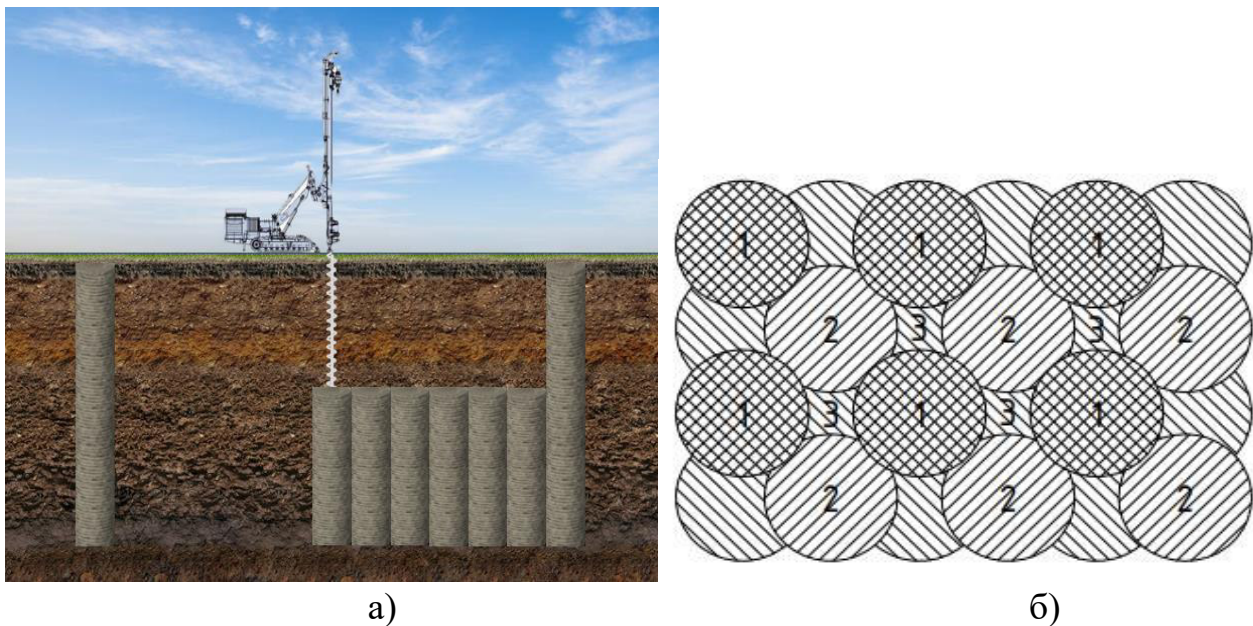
Создание грунтоцементной горизонтальной завесы – плиты из колонн струйной цементации, на определенной глубине, перед выемкой породы для котлована под здание модульного сооружения ППЗРО: а) общий принцип создания грунтоцементной завесы, б) последовательность выполнения этапов создания грунтоцементной «плиты» методом струйной цементации.
